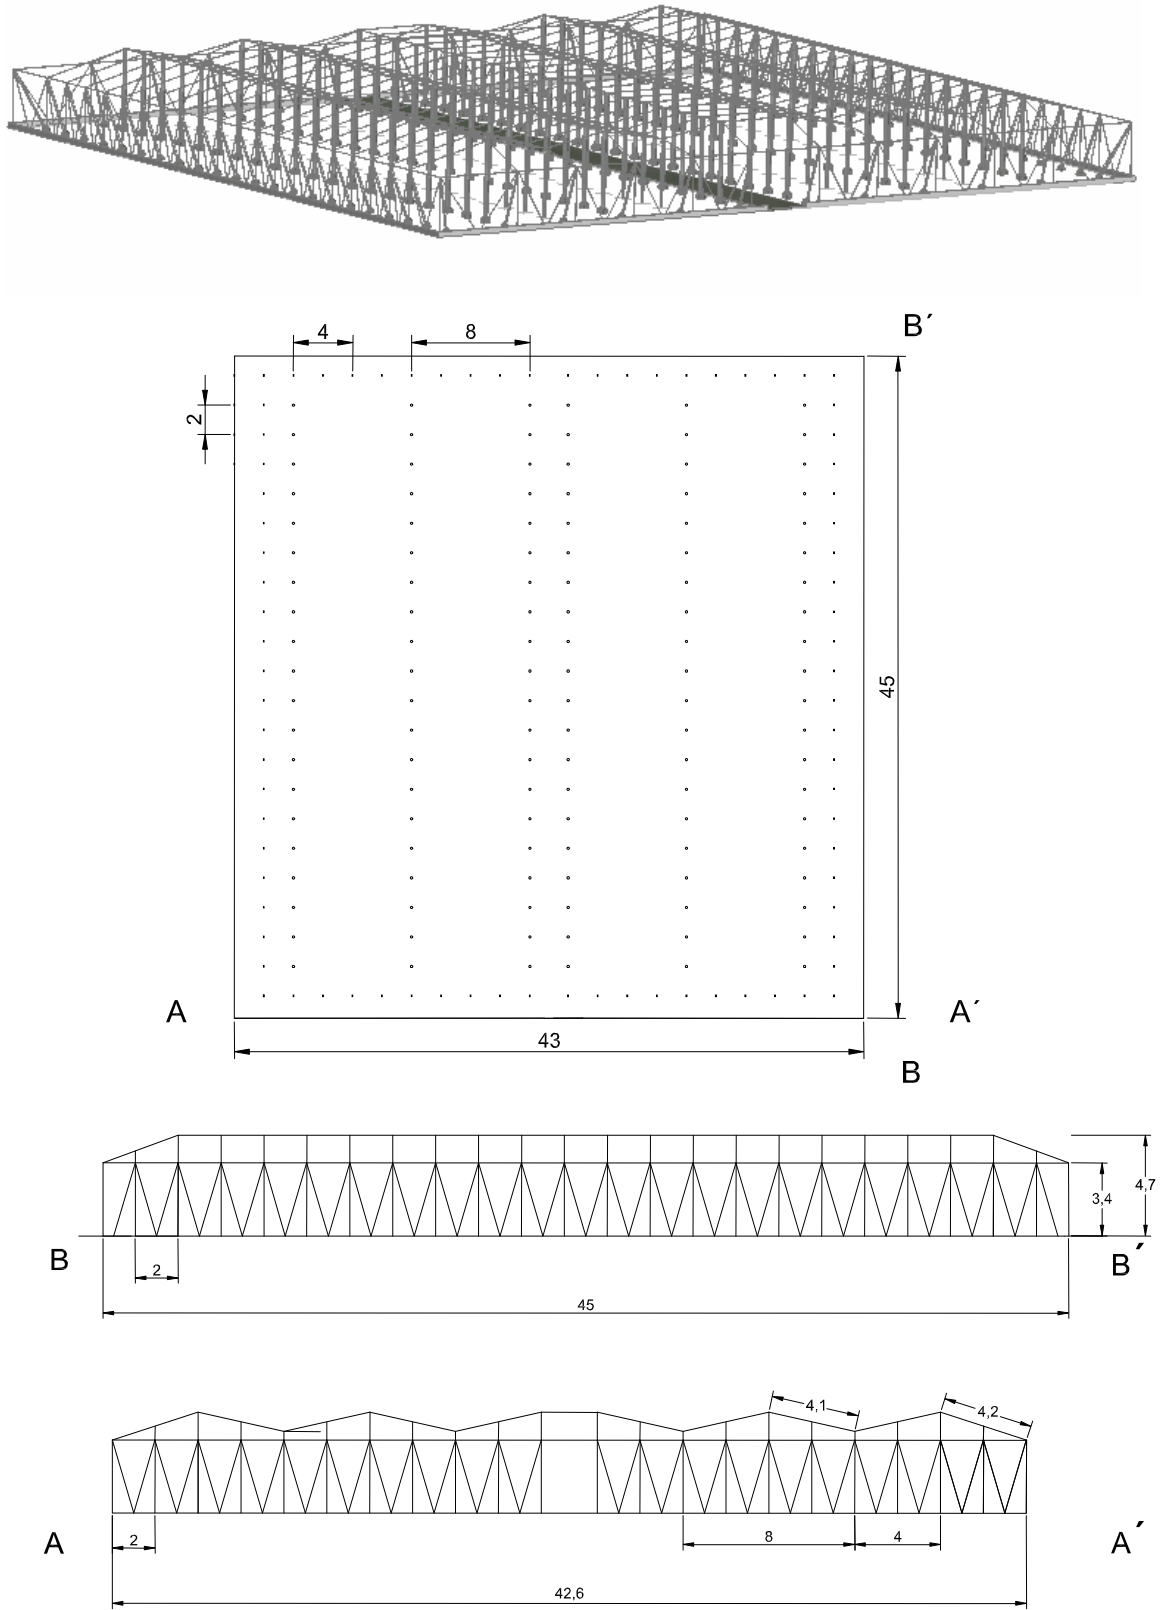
Perspectiva, planta, perfil y alzado del invernadero. Todas las cotas en metros.(Sin escala)
